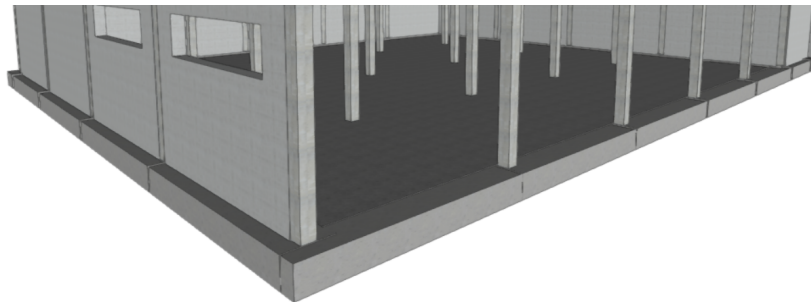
Representación 3D de losa de cimentación. Fuente CYPECAD
